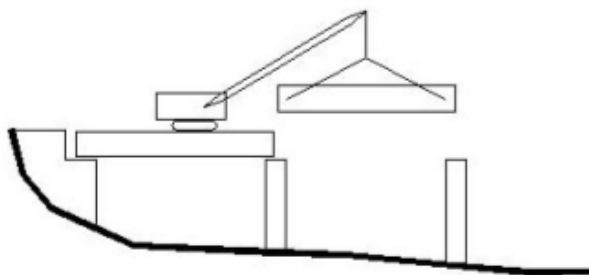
Монтиране на главни греди на мост над река;
